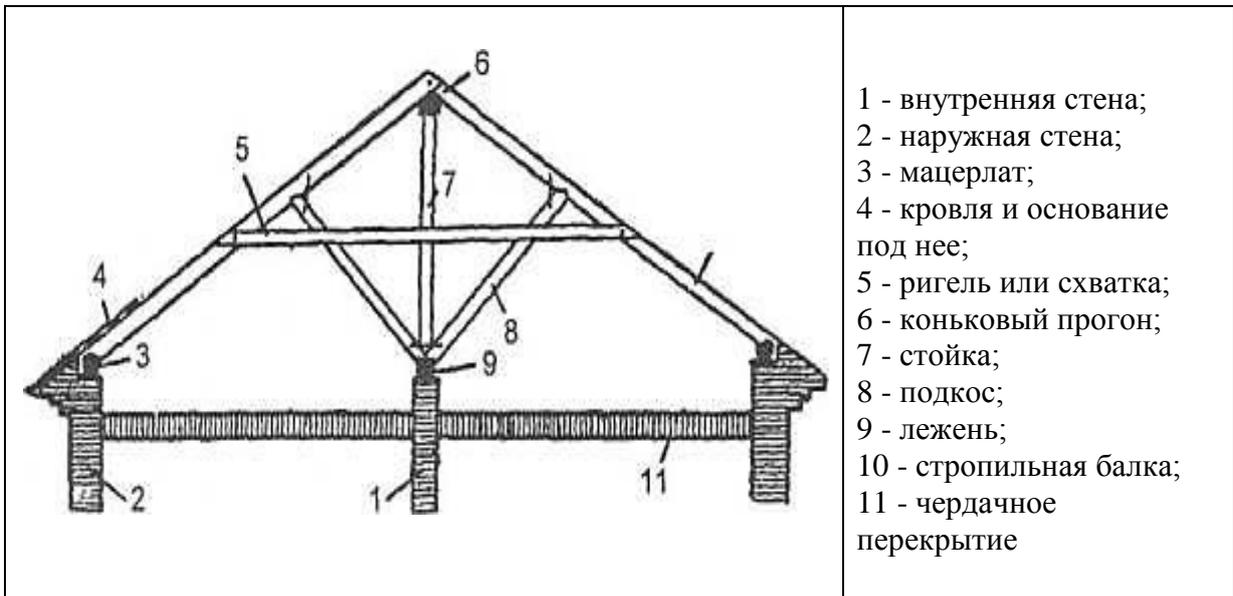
Деревянная конструкция кровли с наклонными стропилами
